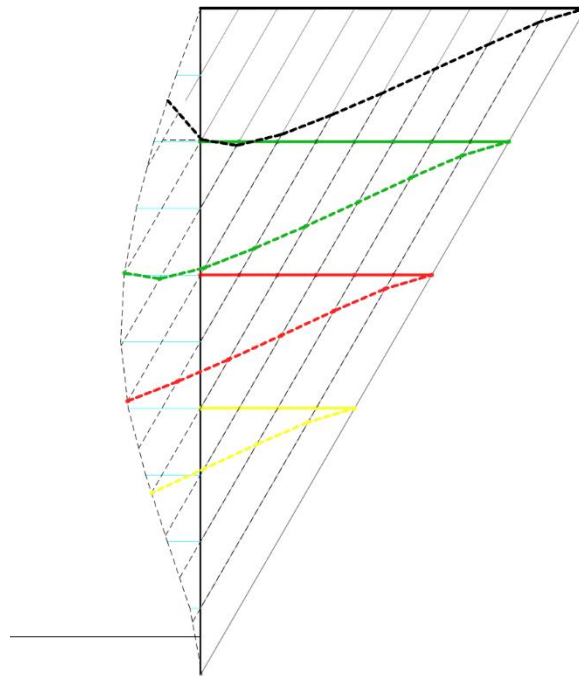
Геометрические построения, соответствующие схеме опыта №9 и включающие в себя совмещение исходной и деформированной схемы подпорной стенки и массива грунта засыпки
